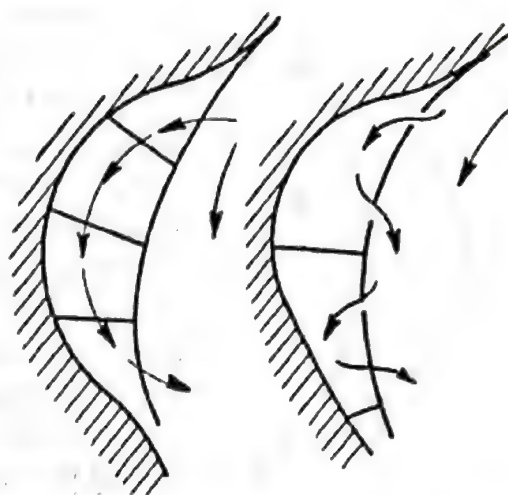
Diguri longitudinale submersibile sau cu ferestre
